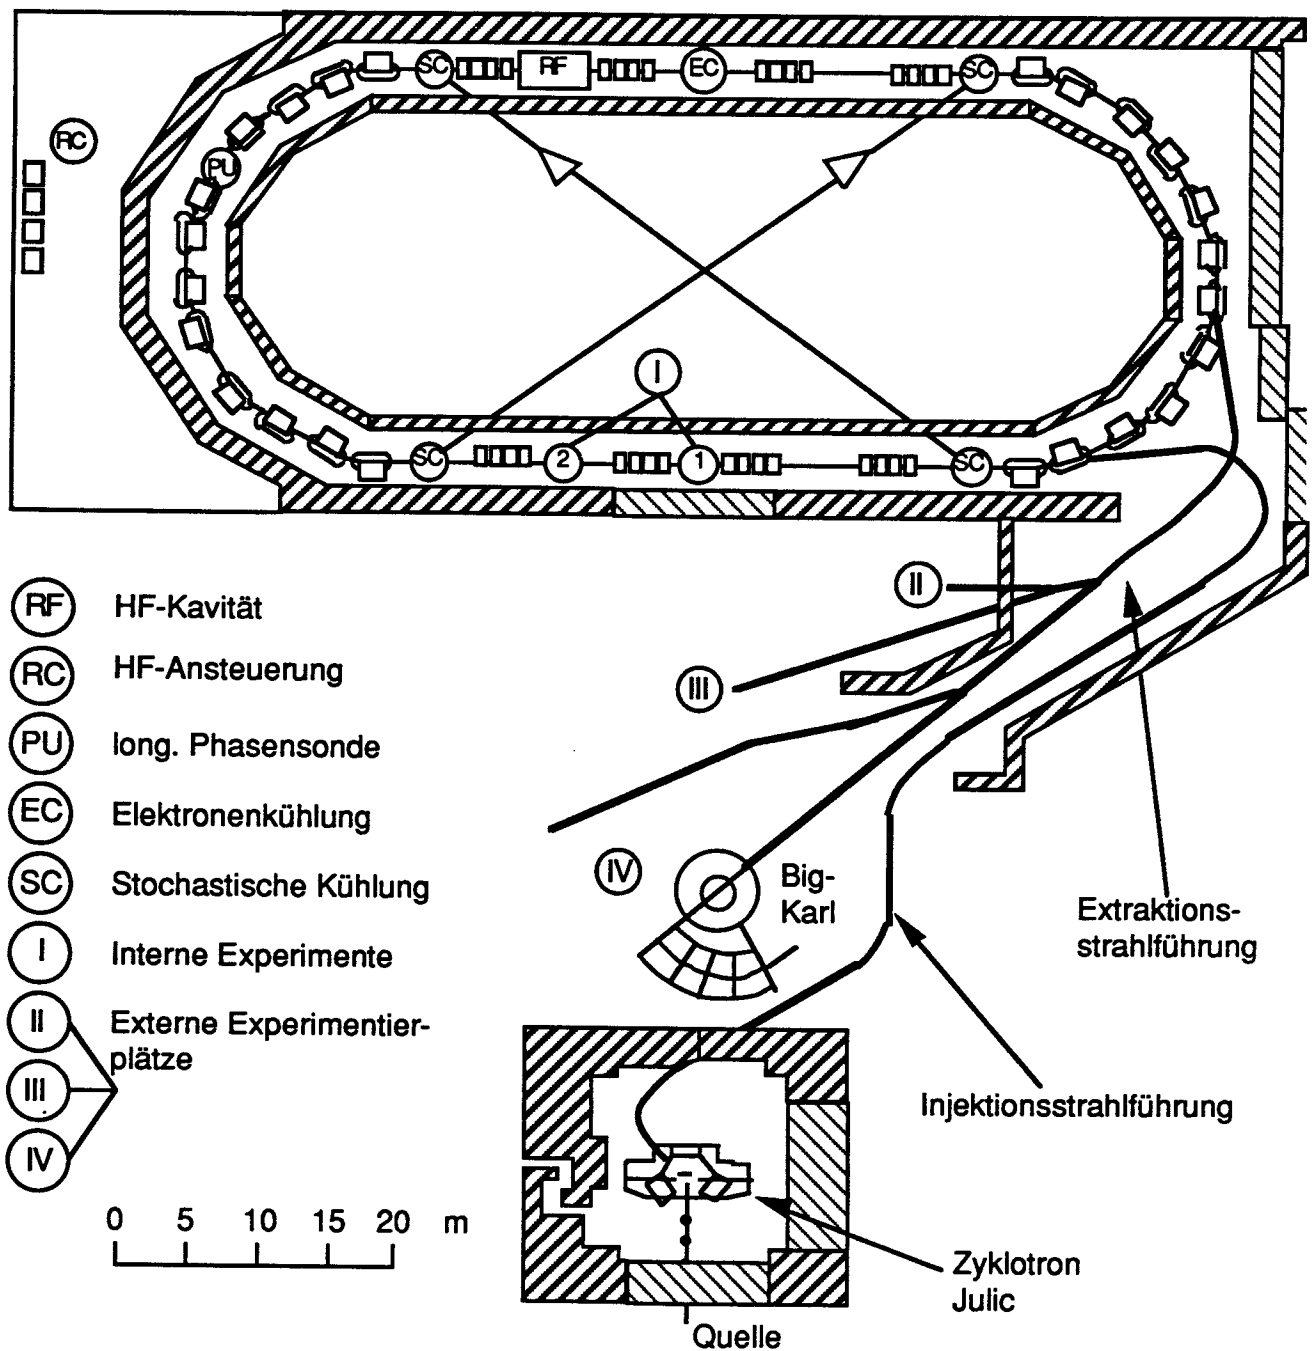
Grundriß des Protonen-Beschleunigers COSY
